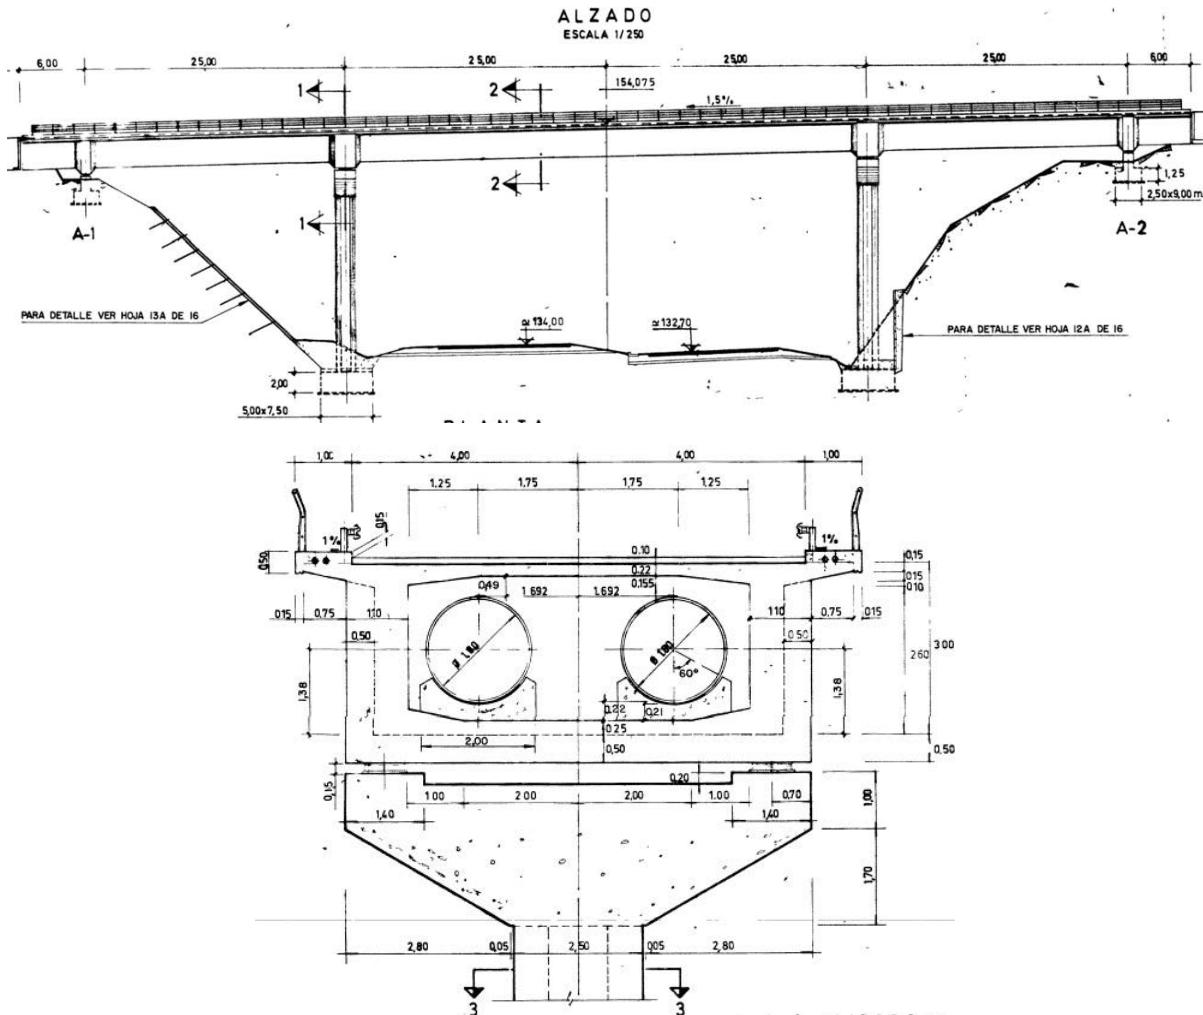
Alzado y sección transversal del acueducto. Planos originales.
